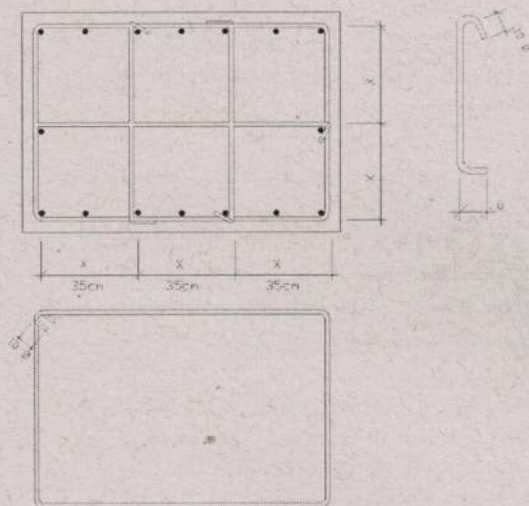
Seção de um pilar destacando a armadura transversal (ACI 318(1992))
